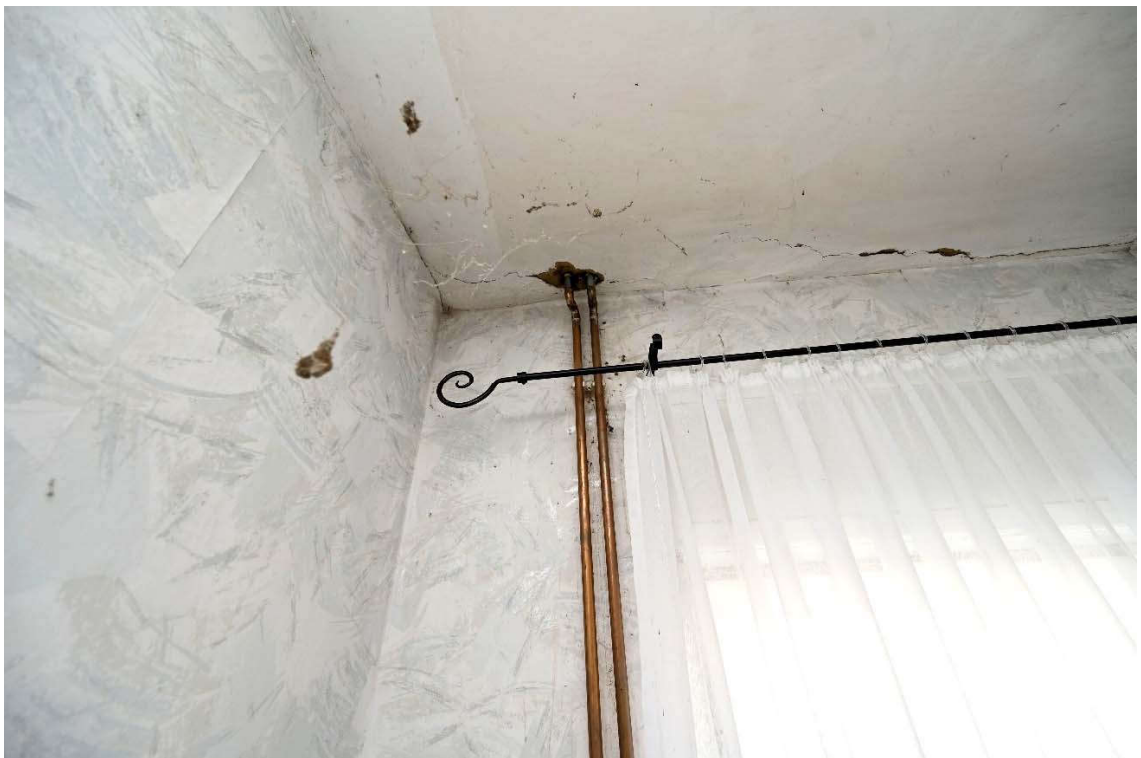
Gebäude A, Erdgeschoss, Zimmer 2, Detail Leitungsführung und Rissbildung
